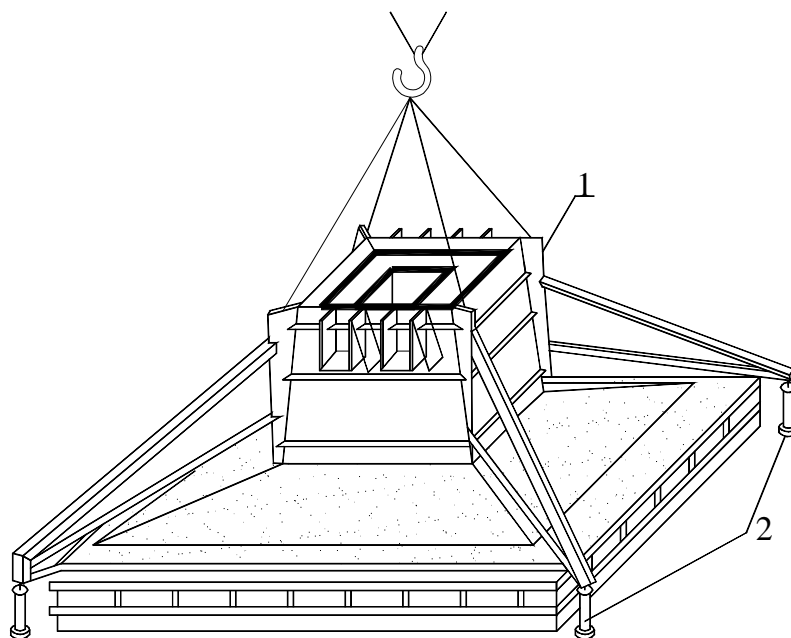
Блок-форма для бетонування фундаментів:
